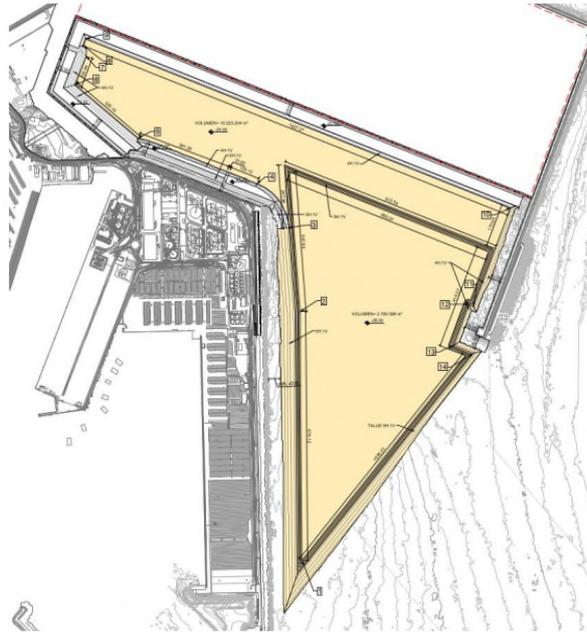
Vista en planta de la zona a dragar y coordenadas de replanteo. Fuente: Proyecto.
